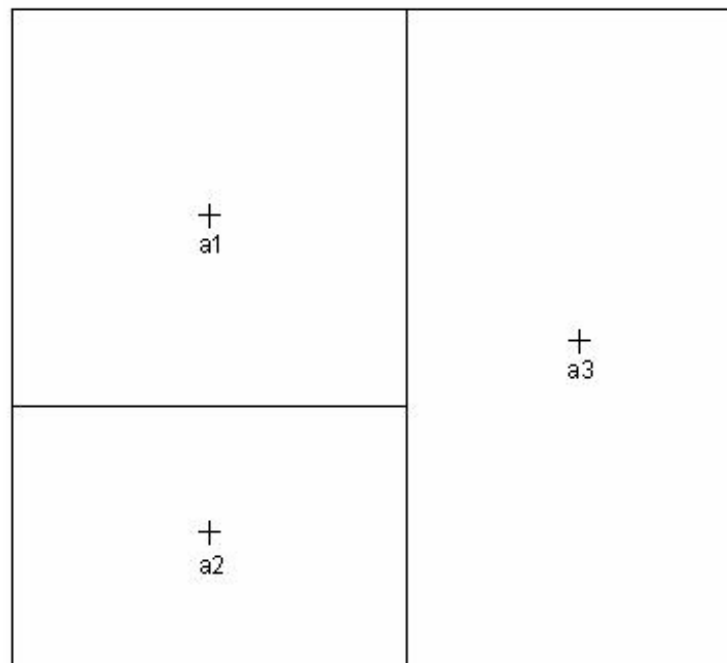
Nomenclatura dos deslocamentos máximos para cada laje do pavimento.
